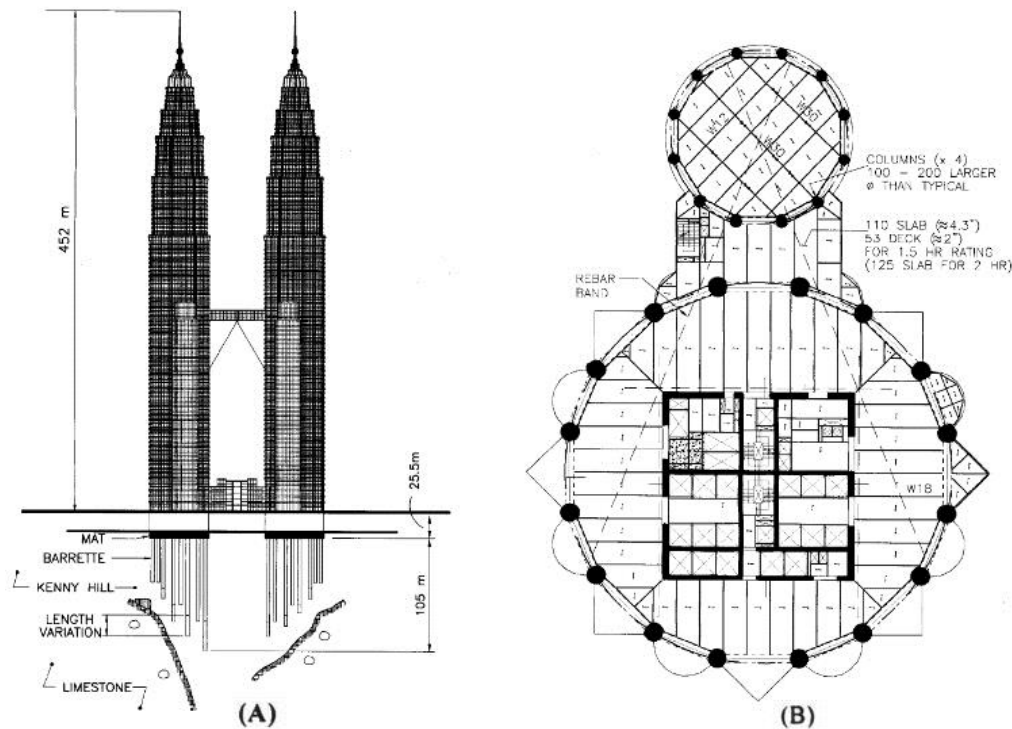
(a) Perfil de Fundação da Torre e (b) Planta do pavimento tipo
